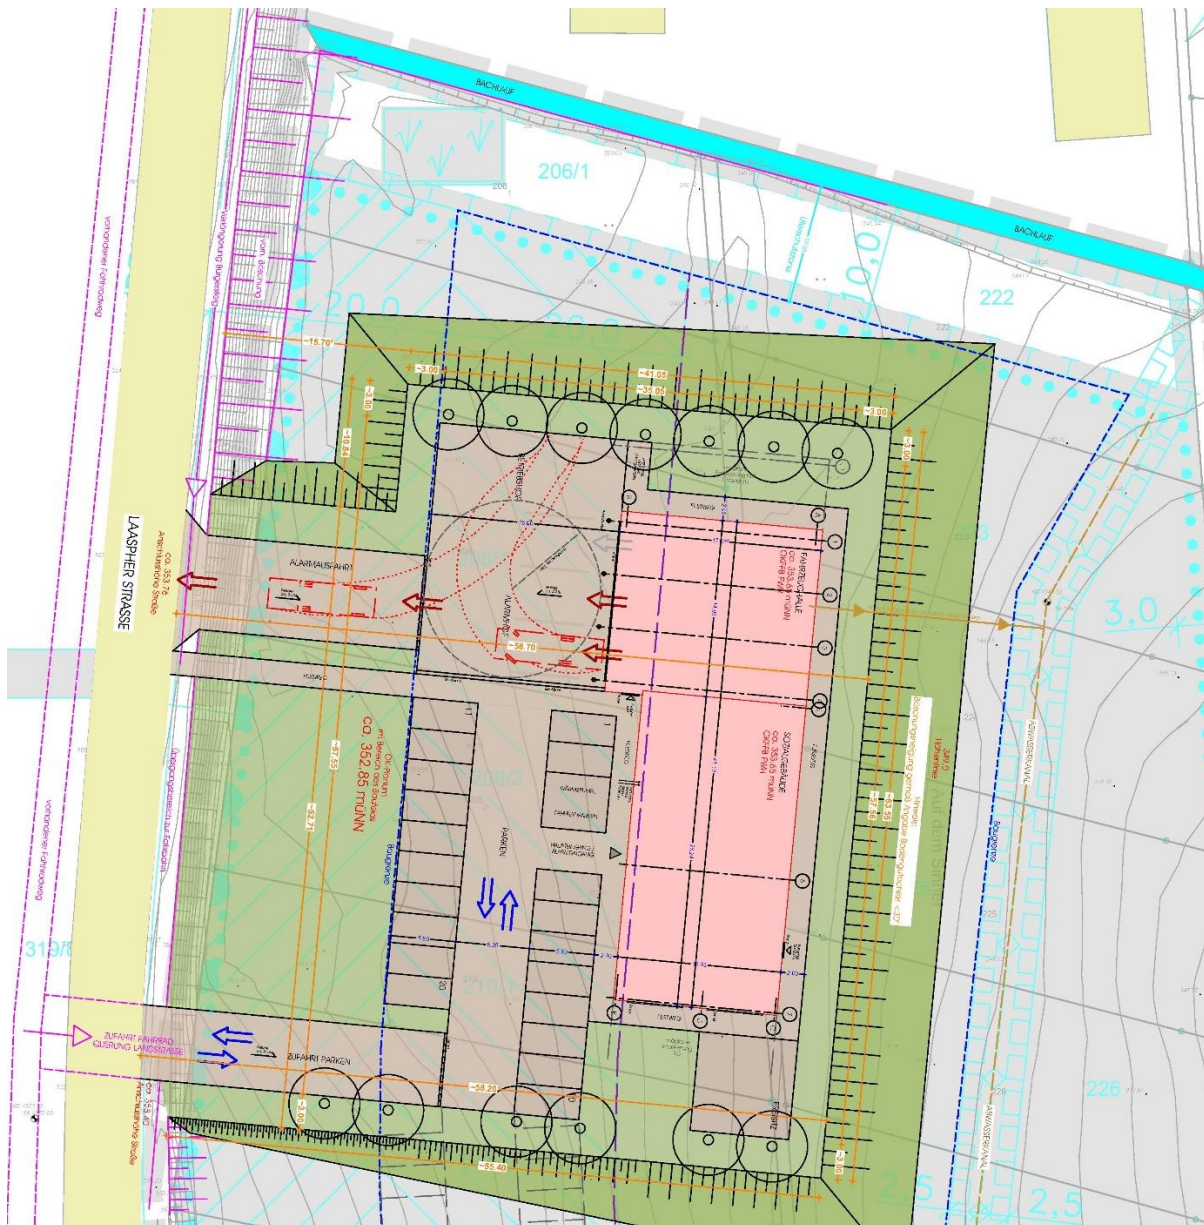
Lageplan der Fachplanung, Stand Oktober 2023 (Quelle: Büro Bautech, Burbach)
